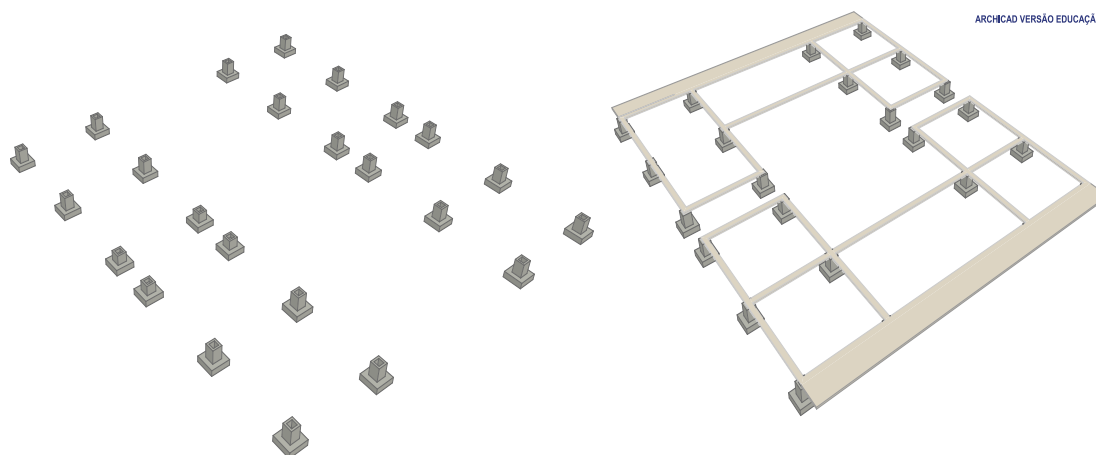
Dimensionamento de sistema de sapatas (Fonte: Autora)
